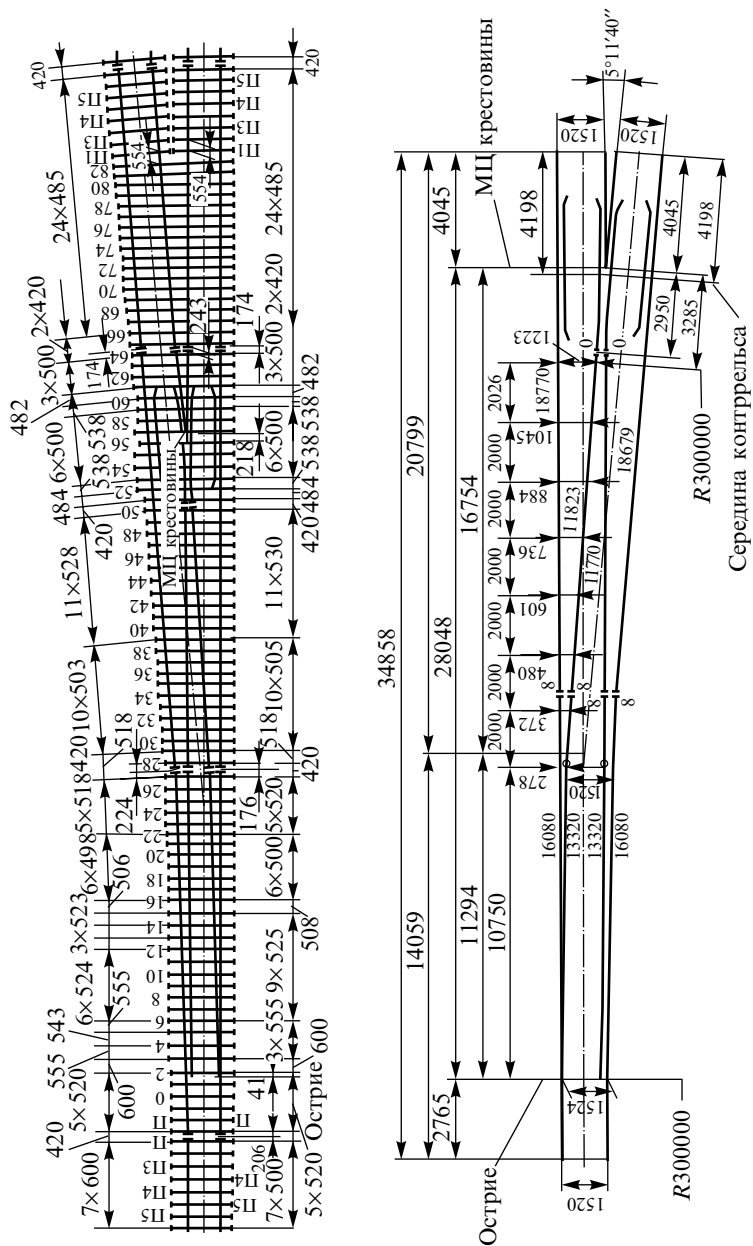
Эпора укладки (а) и схема разбивки (б) стрелочного перевода типа Р65 марки 1/11 на железобетонных брусках (проект 2750)
